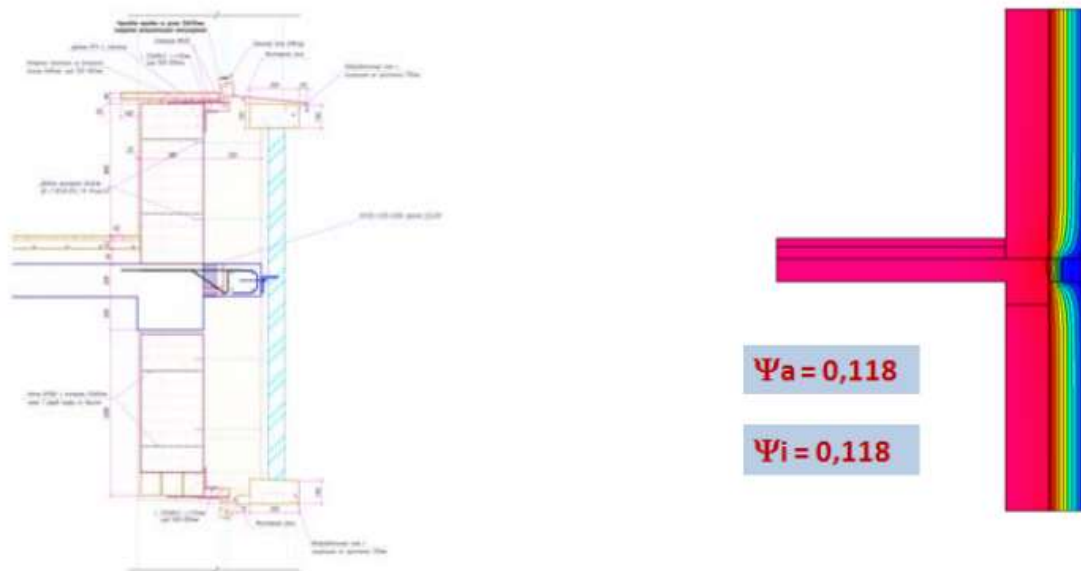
Примикання залізобетонної консолі до зовнішньої стіни через несучий теплоізоляційний елемент в зоні міжповерхового перекриття
